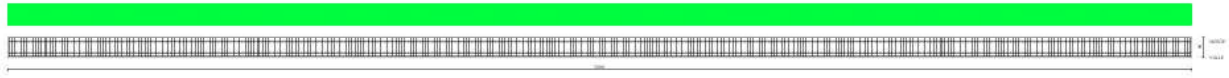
Piastra fondazione dir. Y (Inviluppo)
